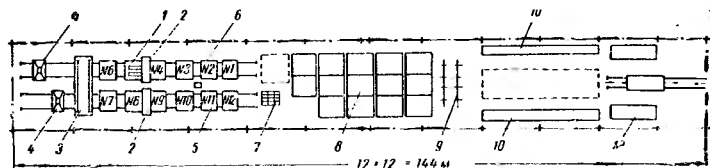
Габаритная схема технологической планировки УТП-1 производства керамзитобетонных наружных стеновых панелей для домов серии 1-464А с вариантом для трехслойных панелей (04-09-7)
